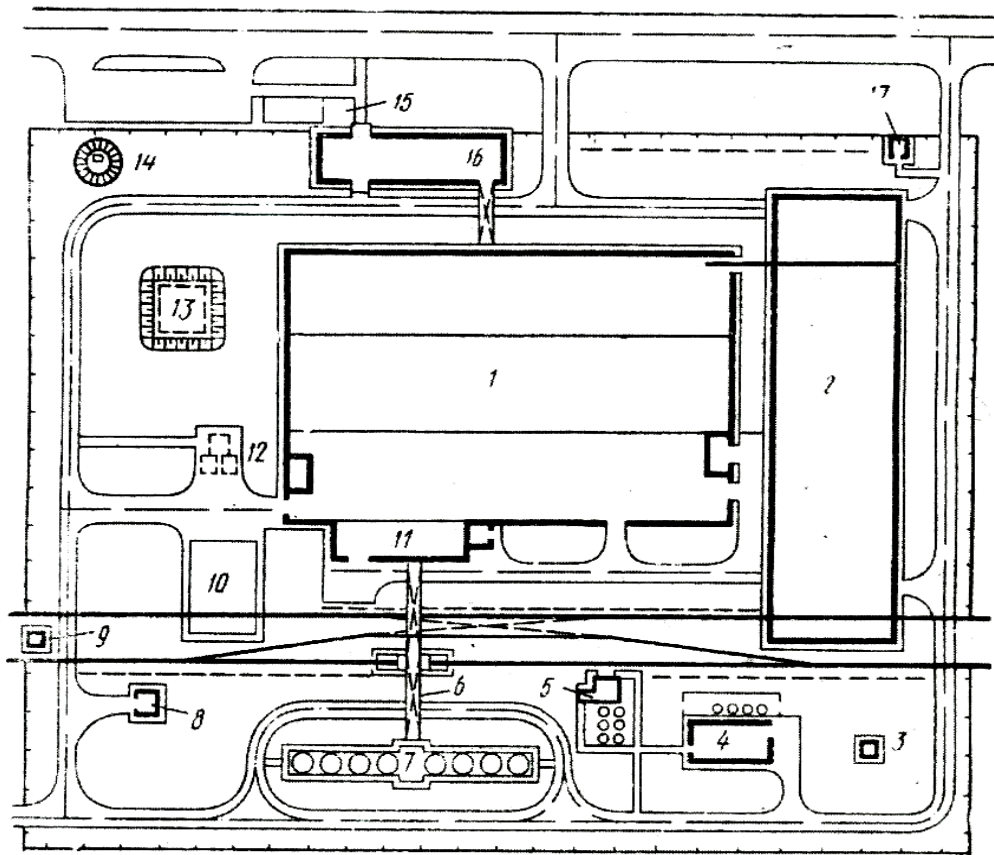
Генплан заводу залізобетонних конструкцій для водогосподарського будівництва:
